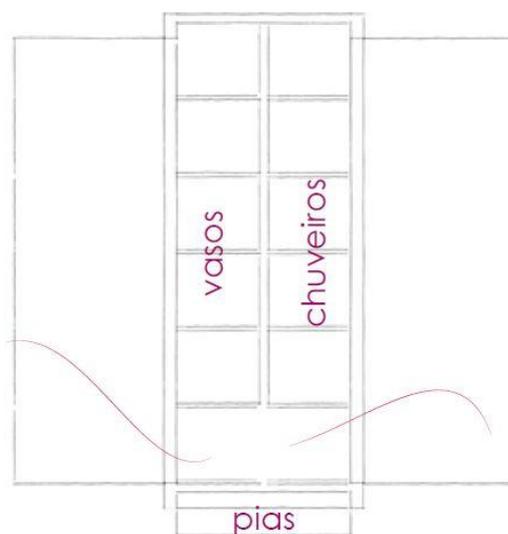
Planta módulo sanitário. Fonte: Peres, 2013.
